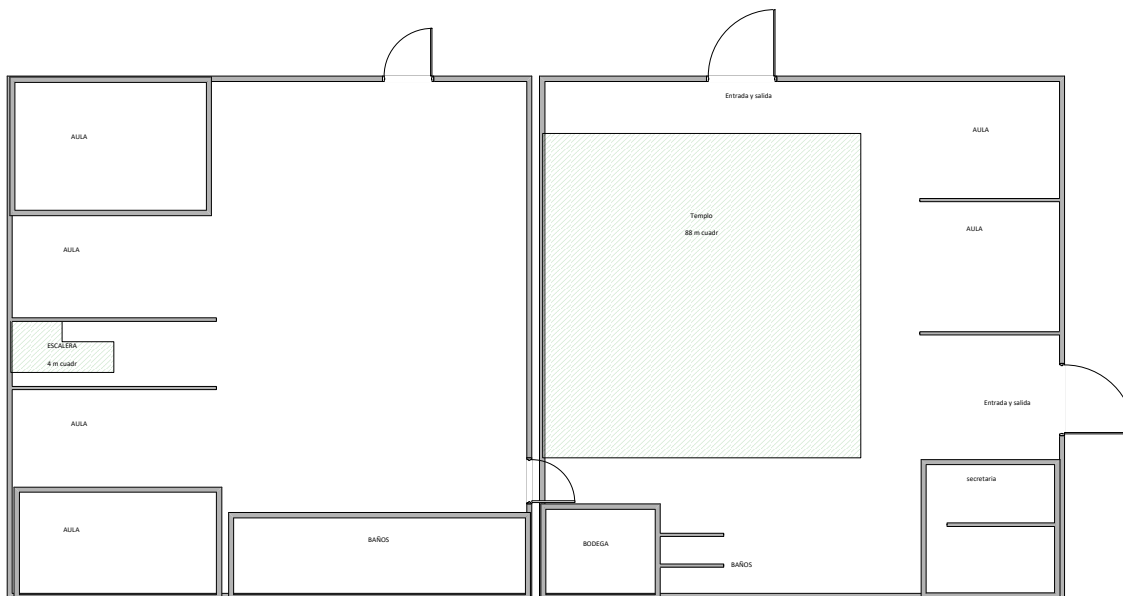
Plano de aulas, oficinas y templo en planta baja del edificio
